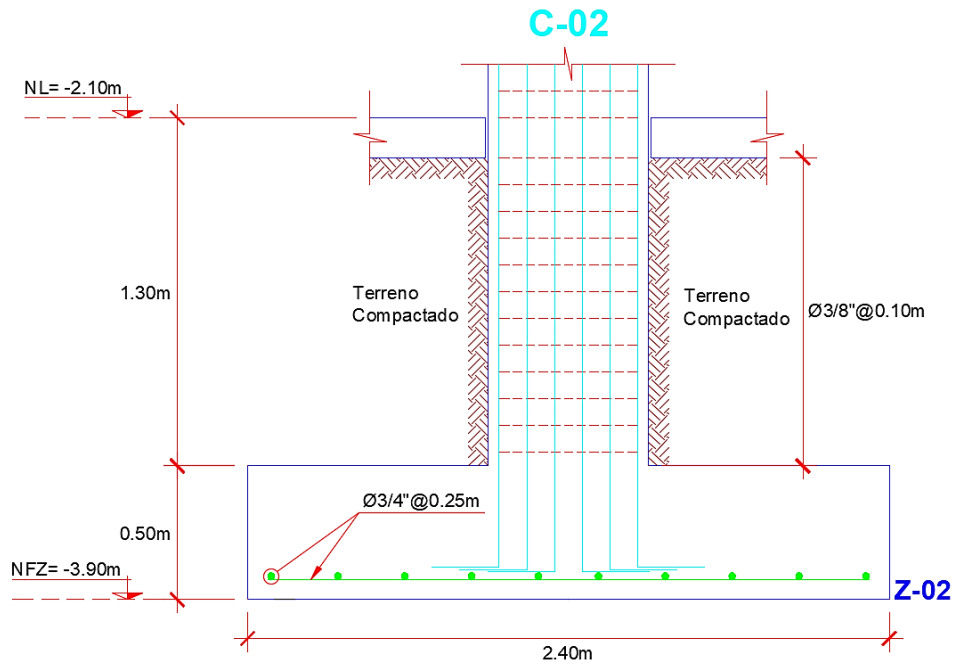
Detalle del refuerzo en concreto armado vista en elevación (Zapata-Relleno fluido)
